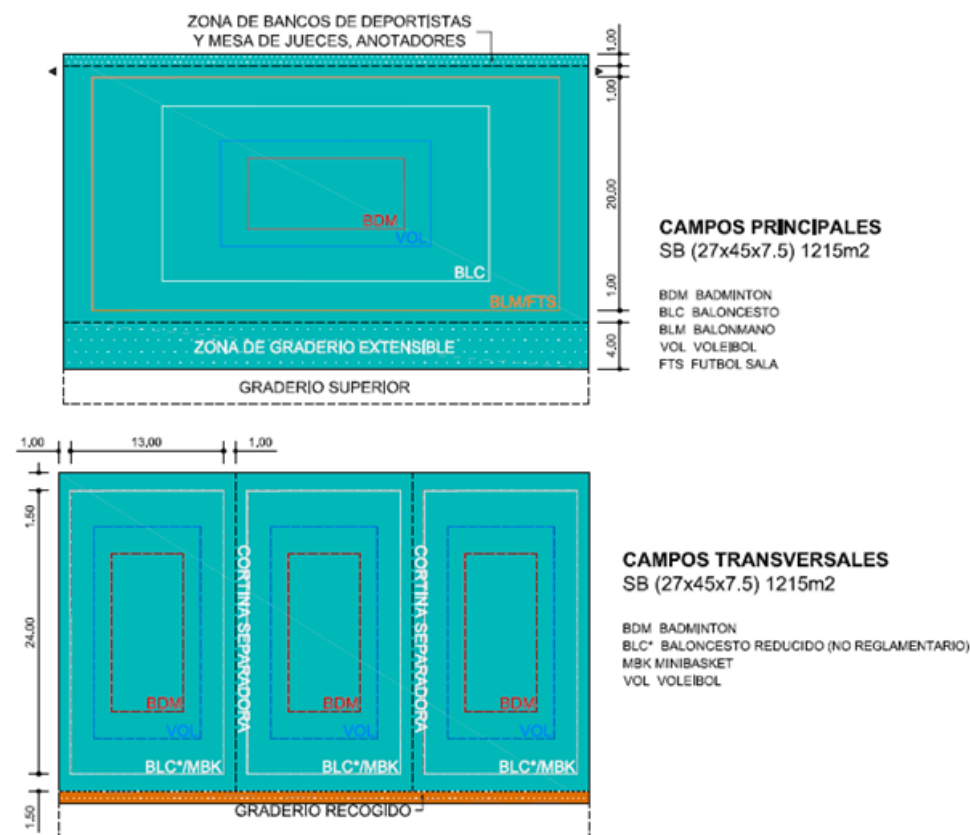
Campos longitudinales y transversales para Sala de Barrio (NIDE).
